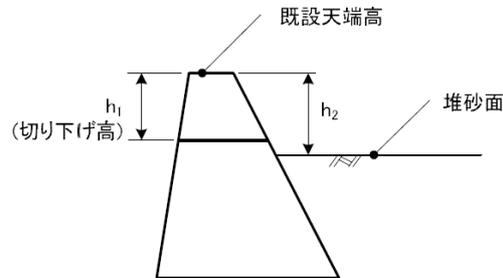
未満砂の砂防堰堤（未満砂状態）
